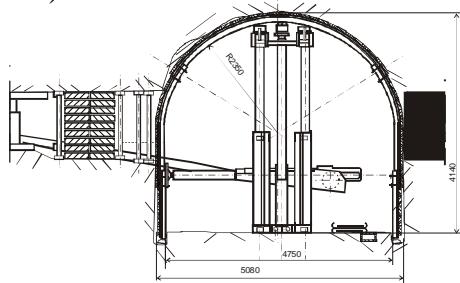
Поперечное сечение выемочной выработки и схема размещения жестких охранных сооружений в ее окрестности
